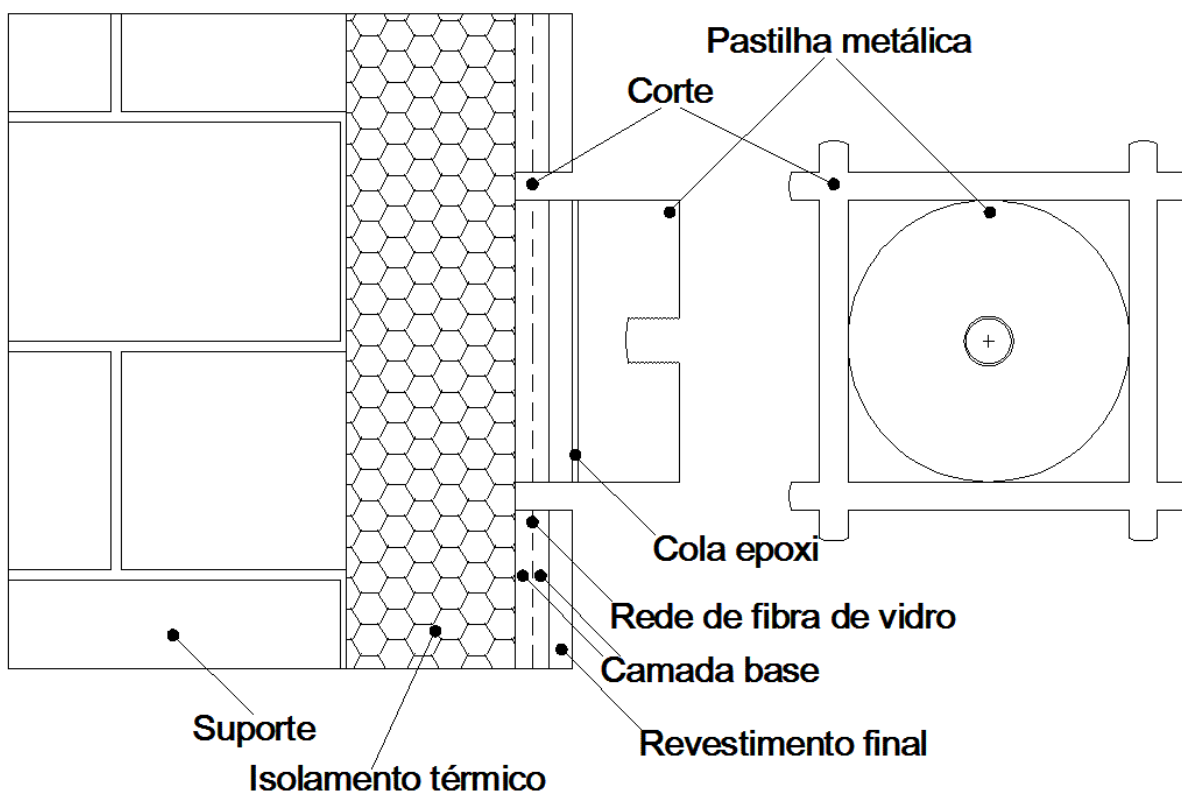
Esquema de princípio da fixação da pastilha metálica ao suporte
